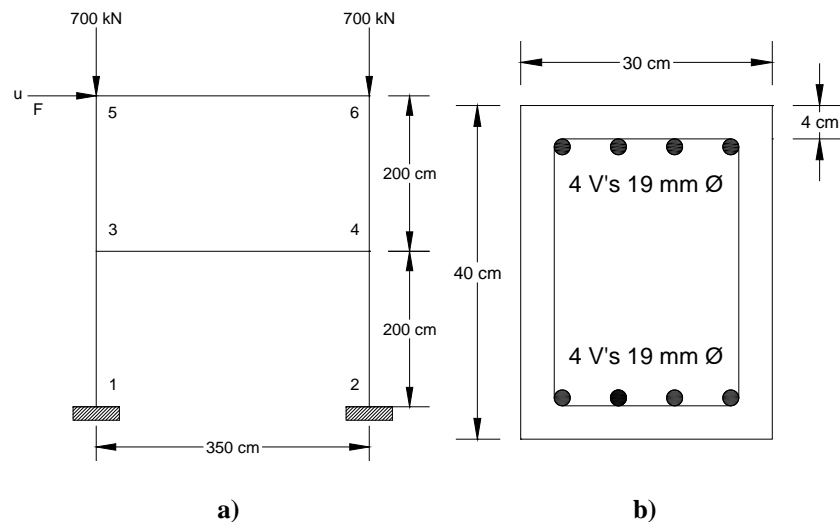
a) Marco estructural y b) Sección transversal de vigas y columnas.
